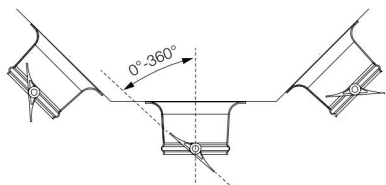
Draufsicht; Düsen-Klappe um 360° drehbar
